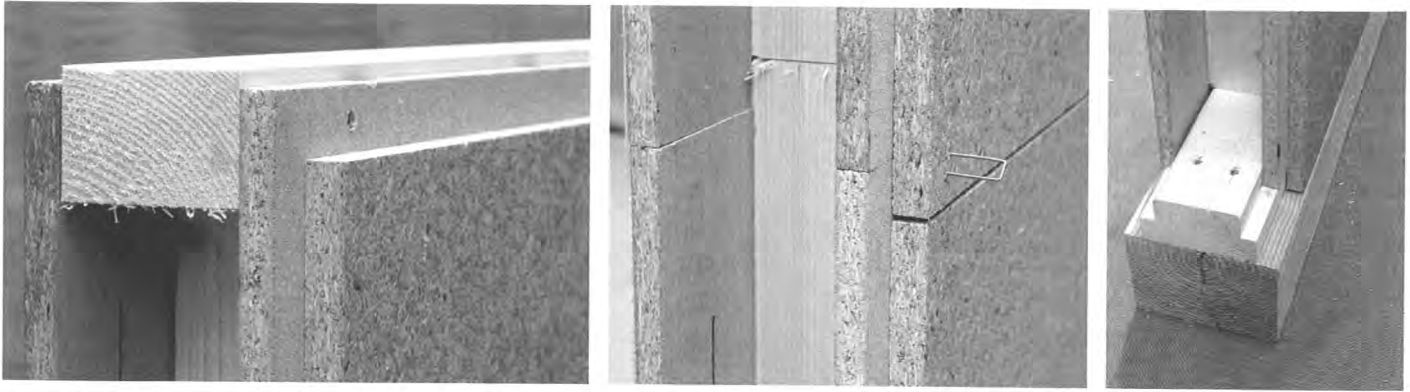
Details der Einzelement-Bauweise: (links) Einbinder bzw. Rähm als oberer Wandabschluss auf oberem Element mit Schrauben befestigt, (mitte) Grundelemente, Überlappung mit Klammern verbunden, (rechts) Schwelle aus Douglasie, Formteil aus Nadelholz zur Befestigung der unteren Elementlage.
